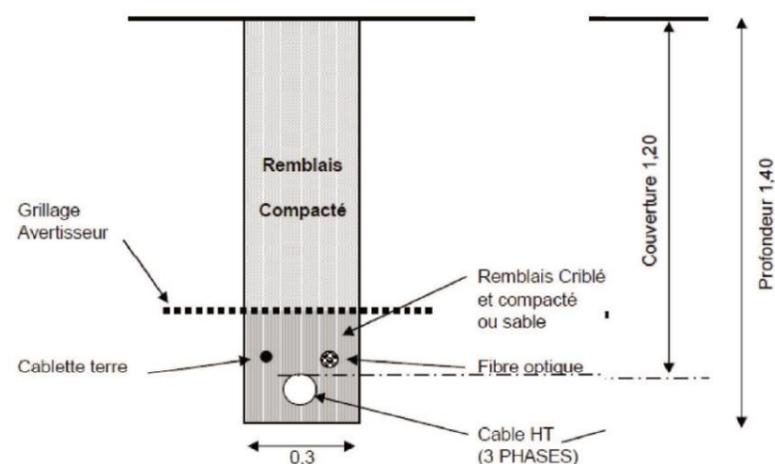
Coupe type d'une tranchée accueillant le câblage (Source : BE Jacquel et Chatillon)
